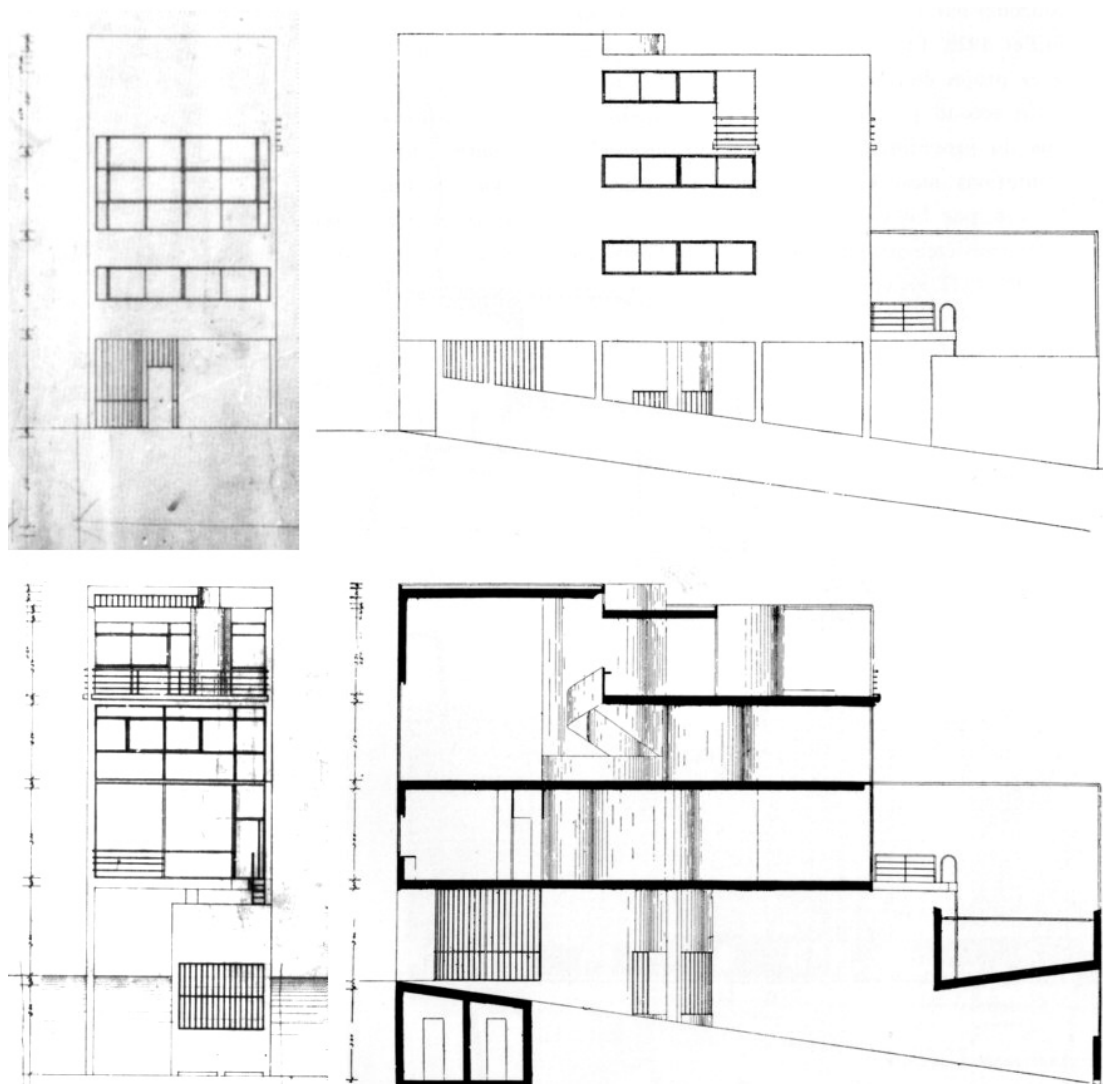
Alçado Norte, Alçado Oeste, Alçado Sul, Corte transversal
